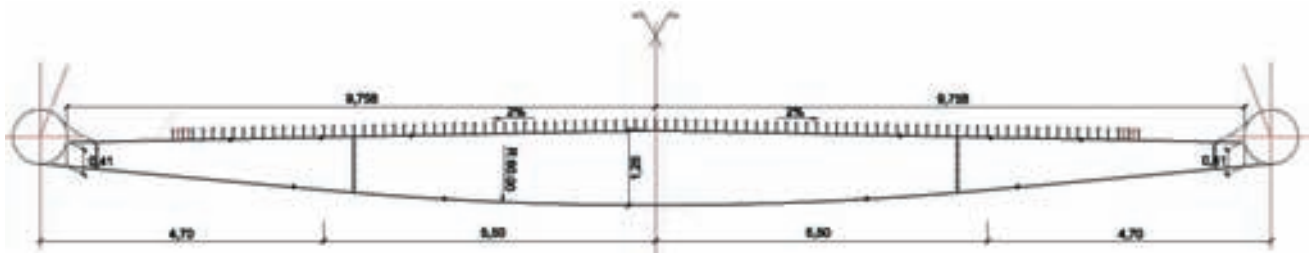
Detalle de una viga transversal tipo del tablero situada cada 5 m
